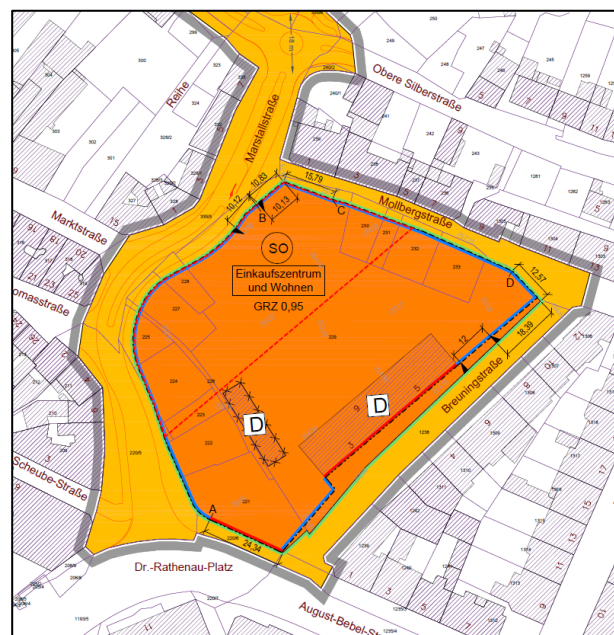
Ausschnitt Planzeichnung (Vorentwurf)
